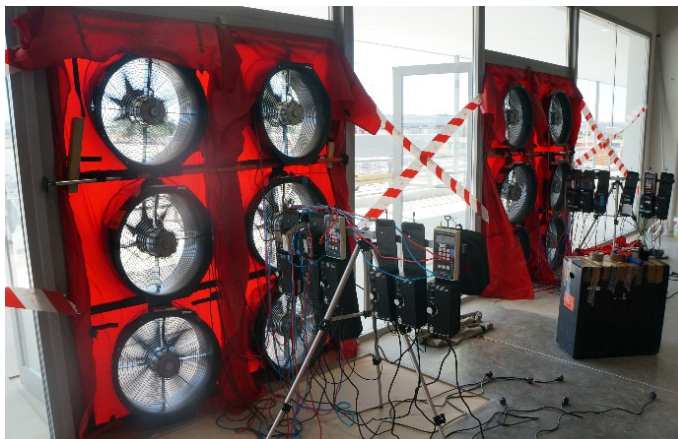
Grupo de 6 ventiladores montado en una de las puertas de acceso a la nave.
